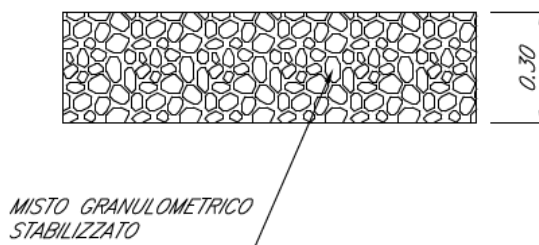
Pacchetto stradale Raccordo 1 e 2
